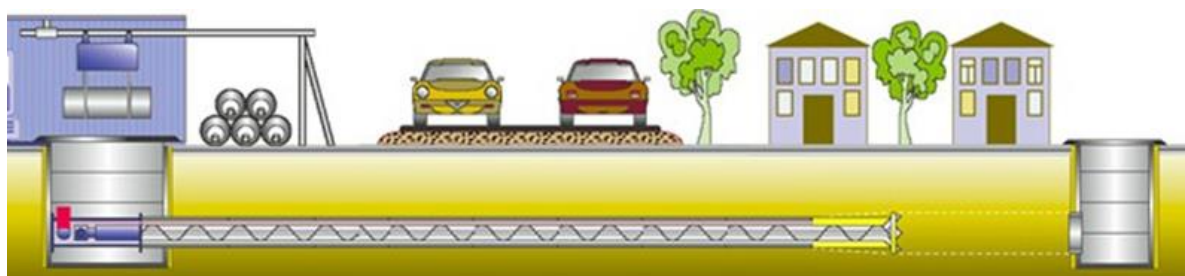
Технологічна схема безтраншейного прокладання трубопроводу із застосуванням мікротунелепрохідницького комплексу
